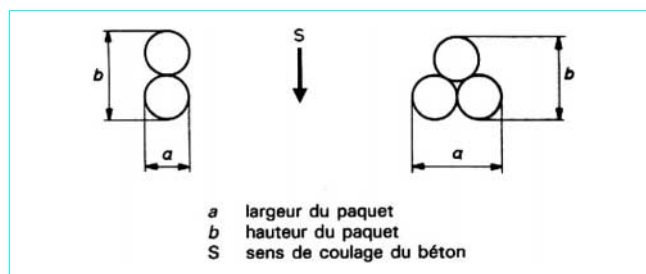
Dispositions des paquets de 2 ou 3 barres
